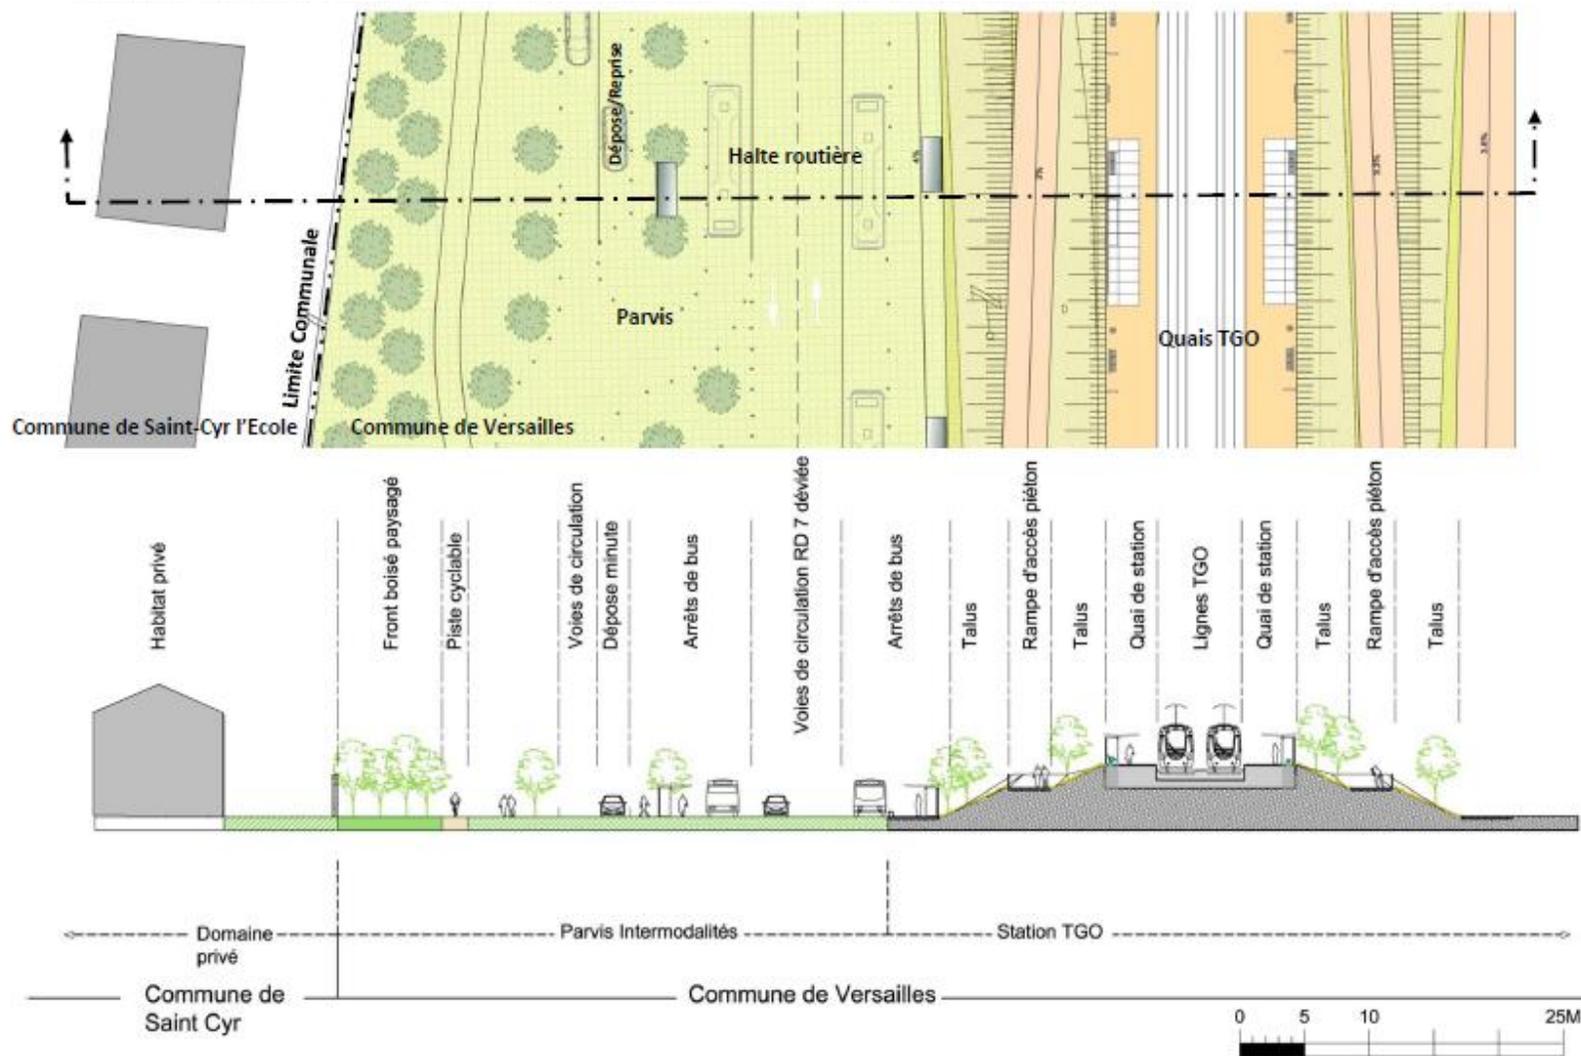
Coupe transversale de la station de Saint-Cyr ZAC
